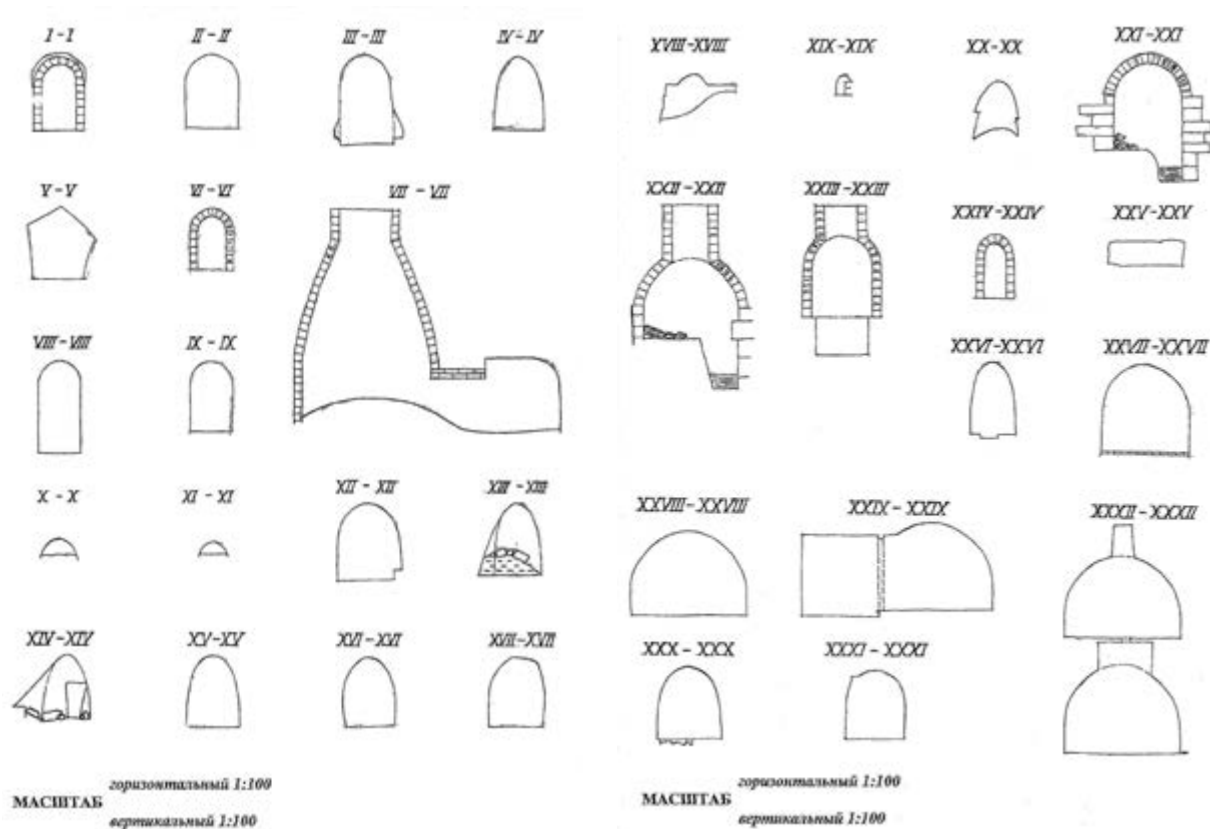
Поперечные сечения выработок подземного комплекса
